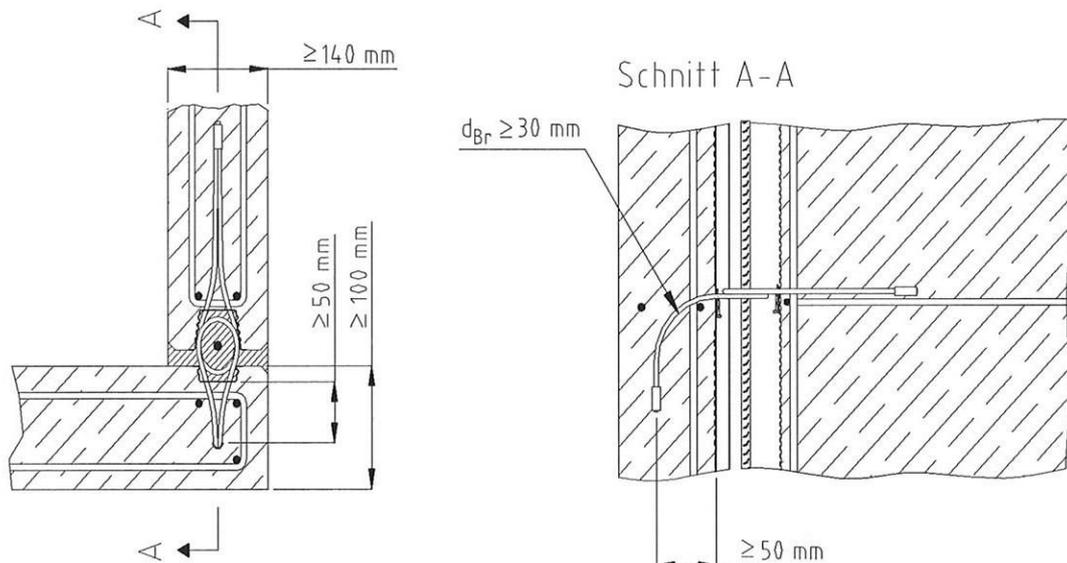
Wand - Wand – Eckverbindung - Detail bei abgewinkelter Seilschlaufe
